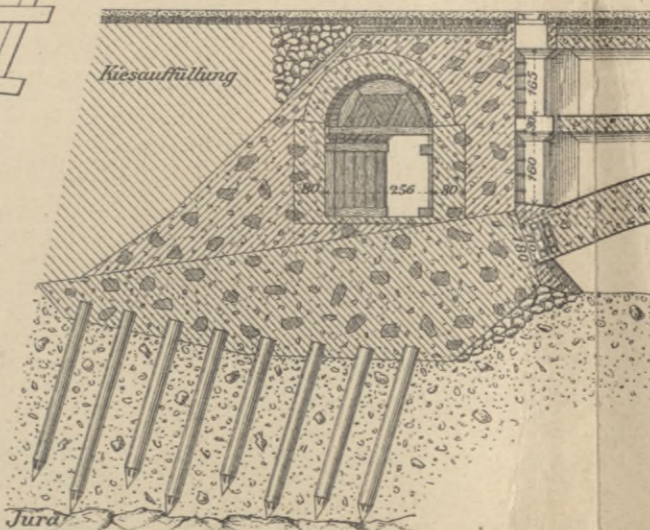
Neue Londonbrücke. M. 1:100. A cross-sectional diagram of the New London Bridge.
